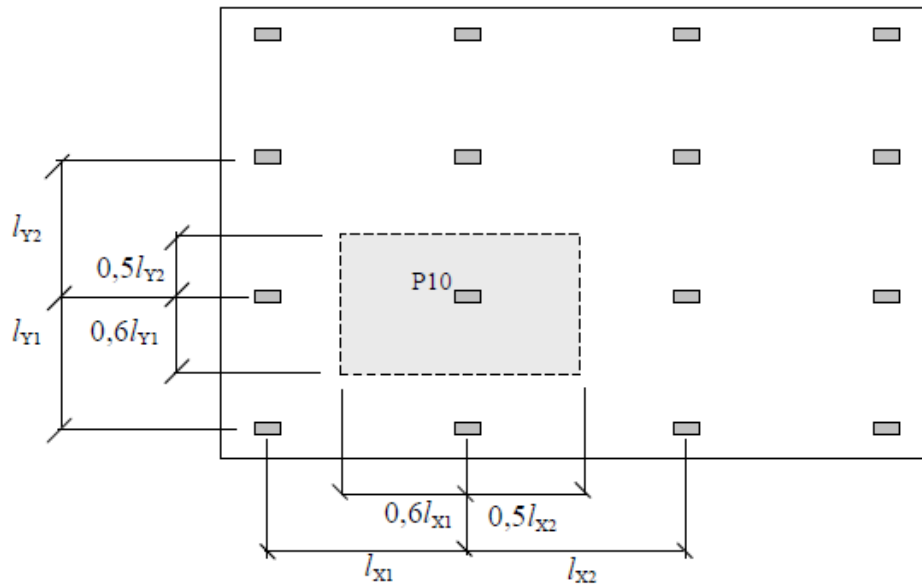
Área de influência para um pilar em uma laje lisa (LONGO, 2012).
